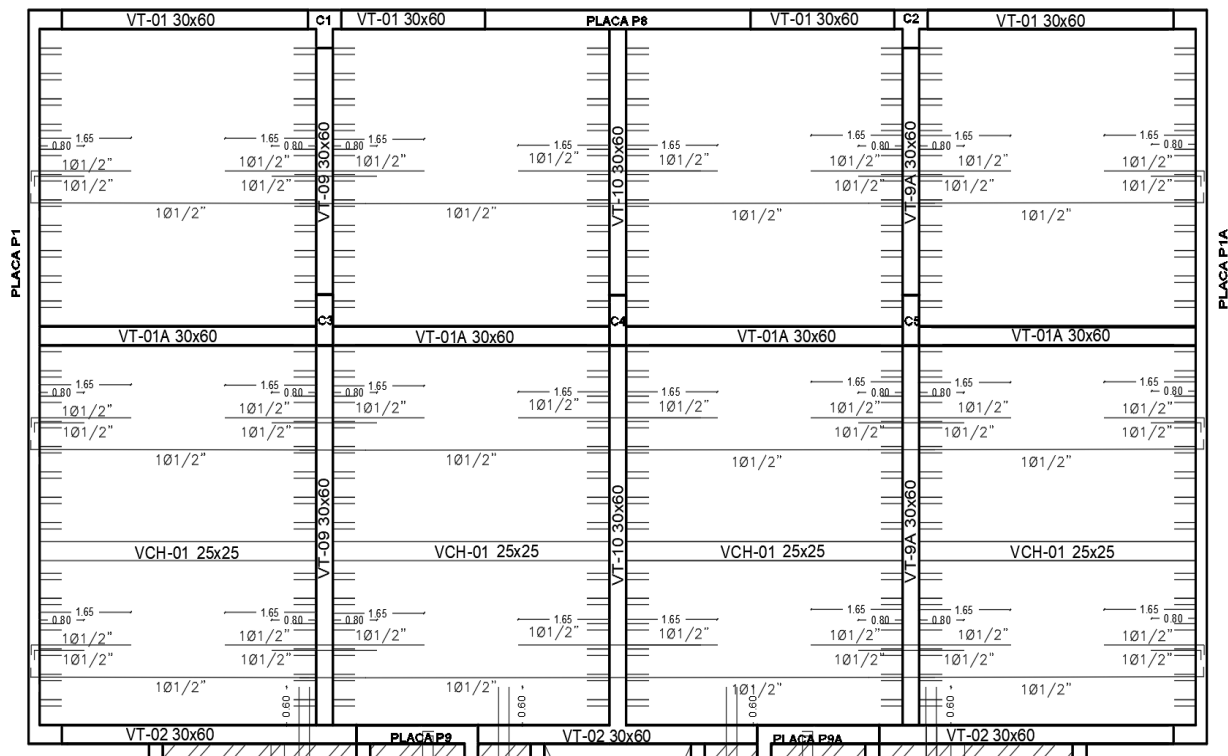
Detalle del refuerzo para la losa aligerada ubicada en 1-5/A-B
